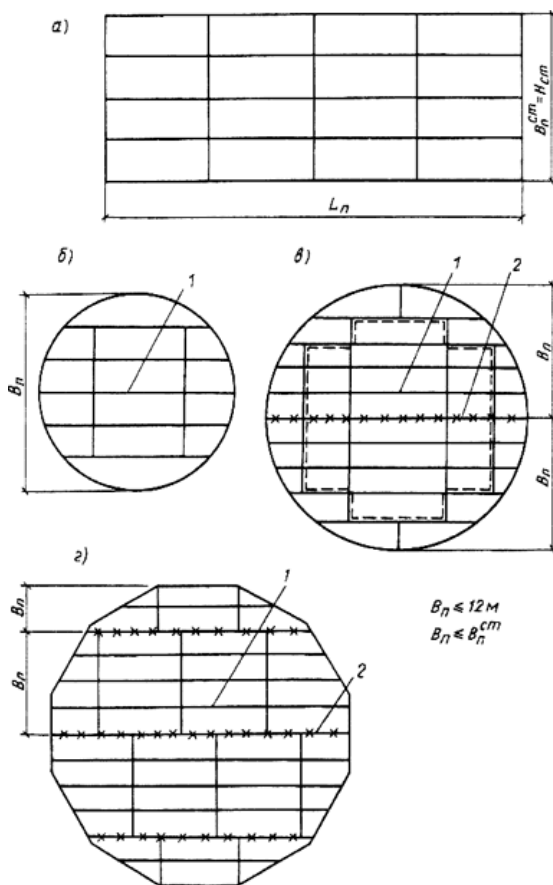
Рулонлируемые конструкции резервуара: а - рулонлируемое полотнище стенки; L_n - длина полотнища стенки; B_n^{cm} - ширина полотнища стенки; H^{cm} - высота полотнища стенки; б, в - рулонлируемые полотнища днища круглого очертания; B_n - ширина полотнища днища; 1 - заводской сварной шов; 2 -
